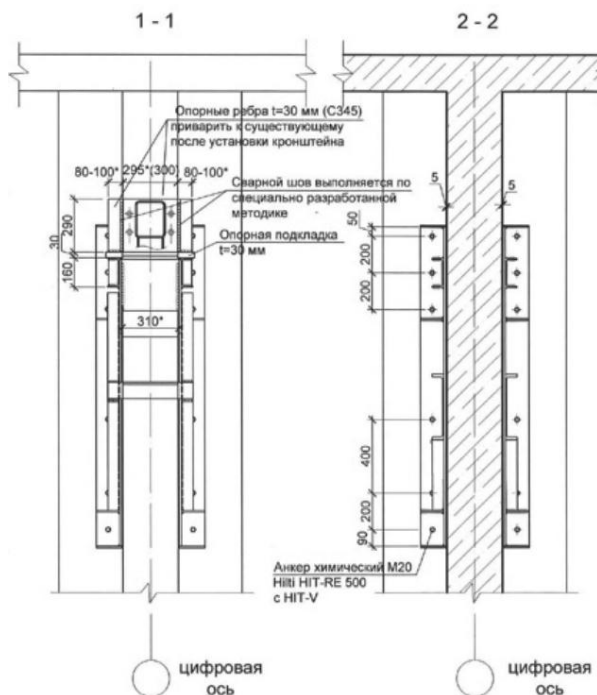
Конструкция усиления коротких железобетонных консолей в составе пилонов (разрезы 1-1 и 2-2)
